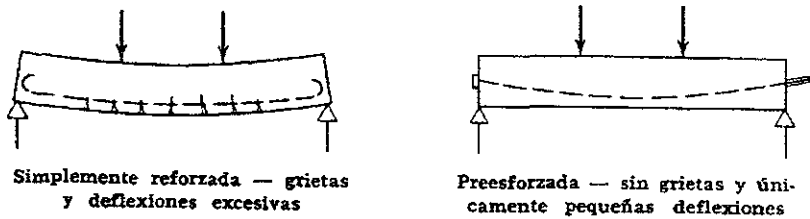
Viga de concreto utilizando acero de alta resistencia
